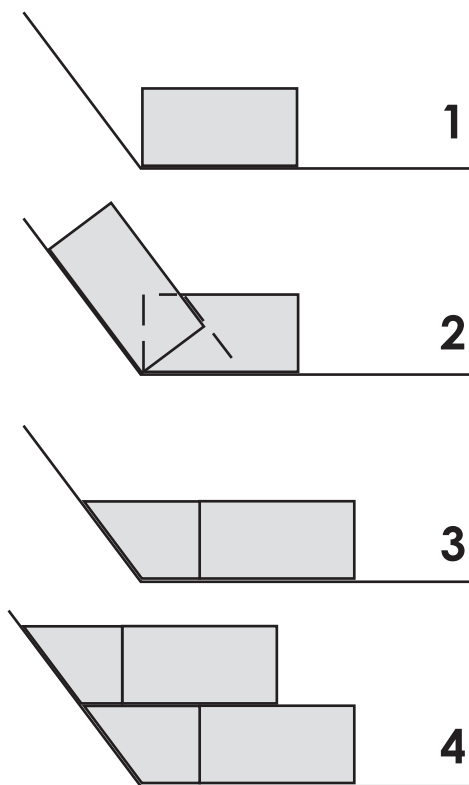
Раскладка теплоизоляционных плит при двухслойной укладке.
